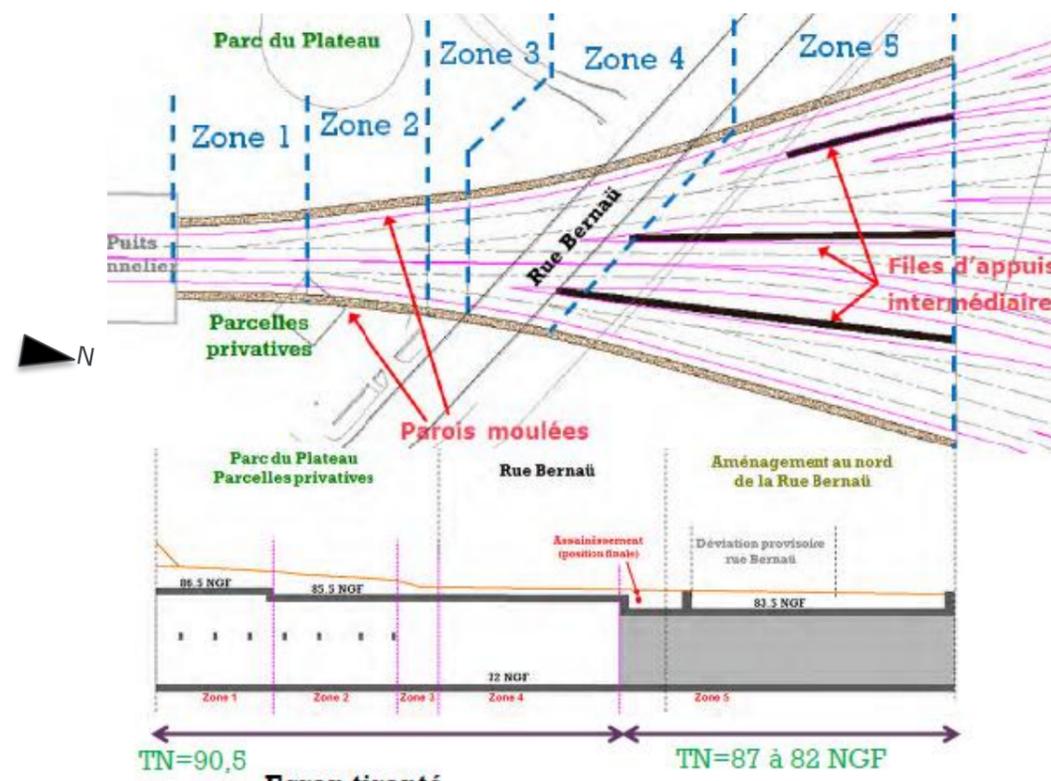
SMR : Schéma de principe de la structure de l'ouvrage d'entonnement - vue en plan et coupe
